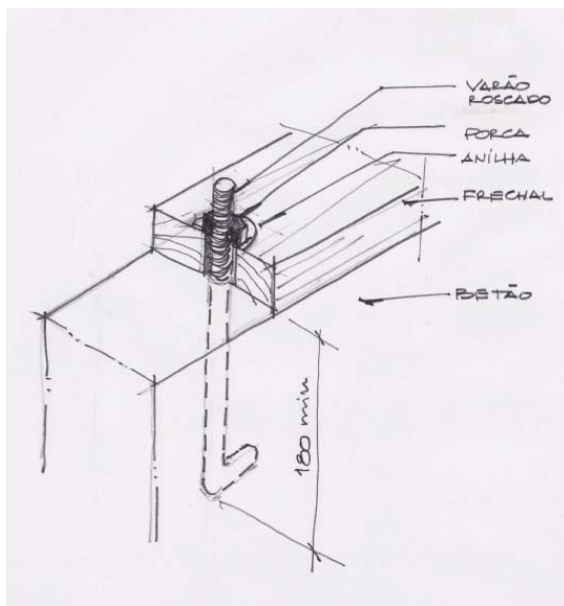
Frechal em fundação de betão. (des. autor)
